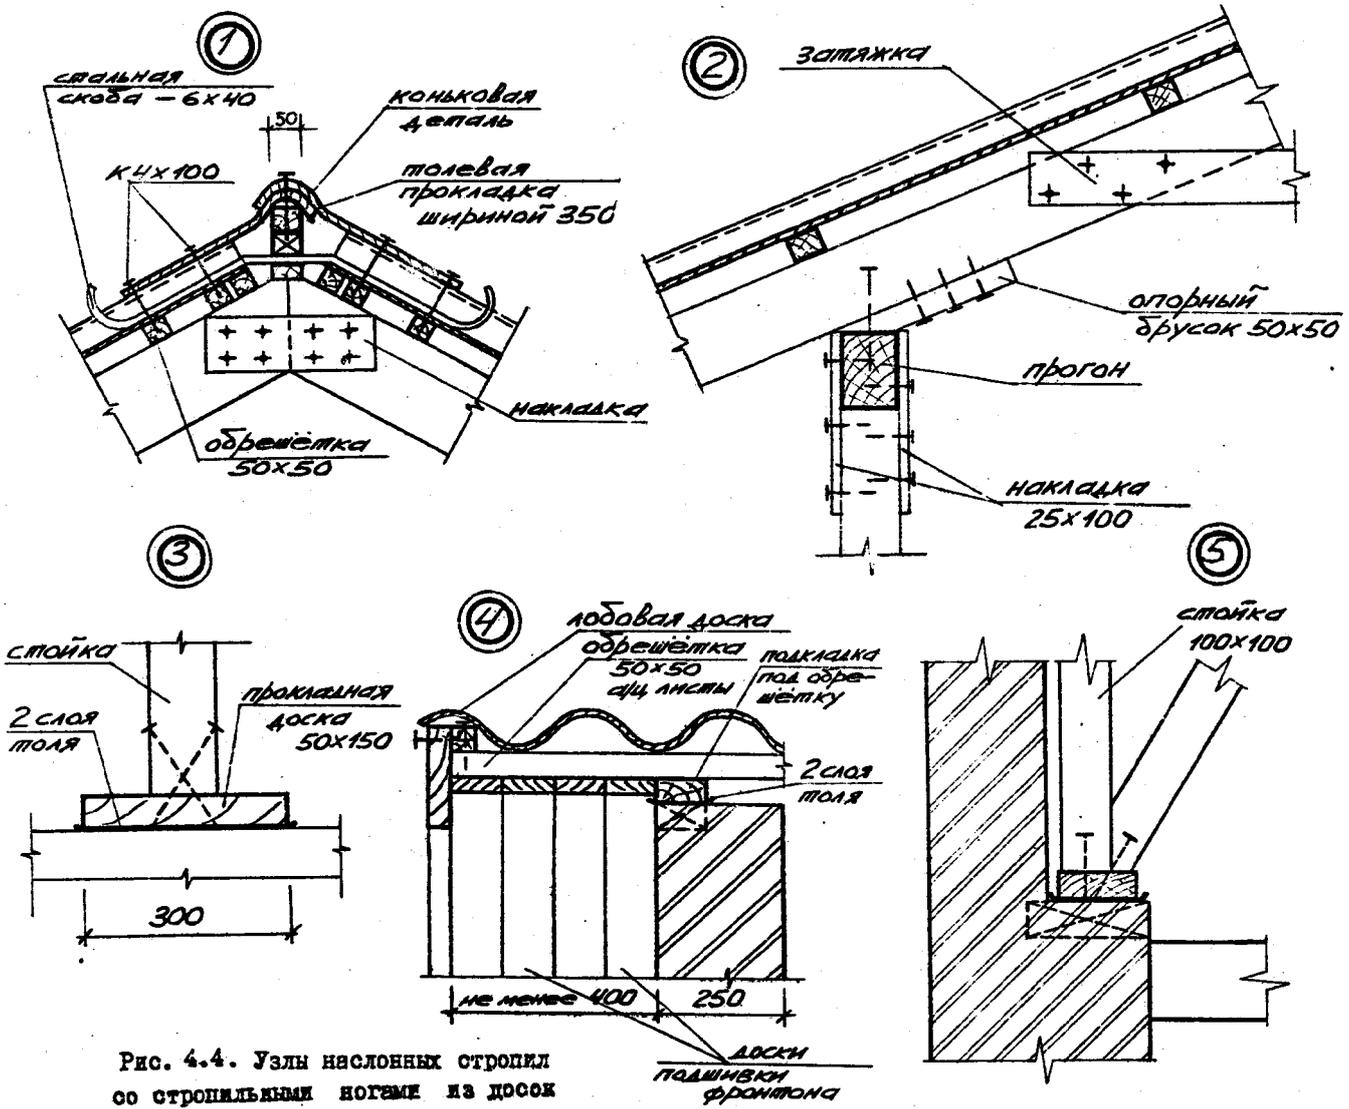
Узлы наслонных стропил со стропильными ногами из досок
